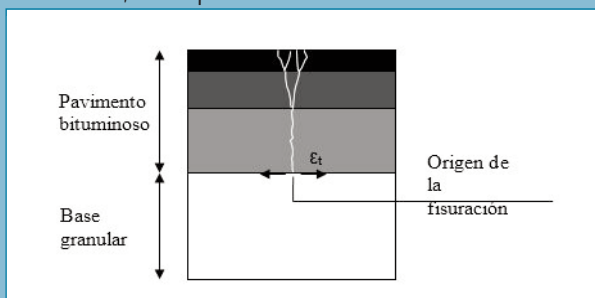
Propagación de la fisuración estructural en un firme flexible.
